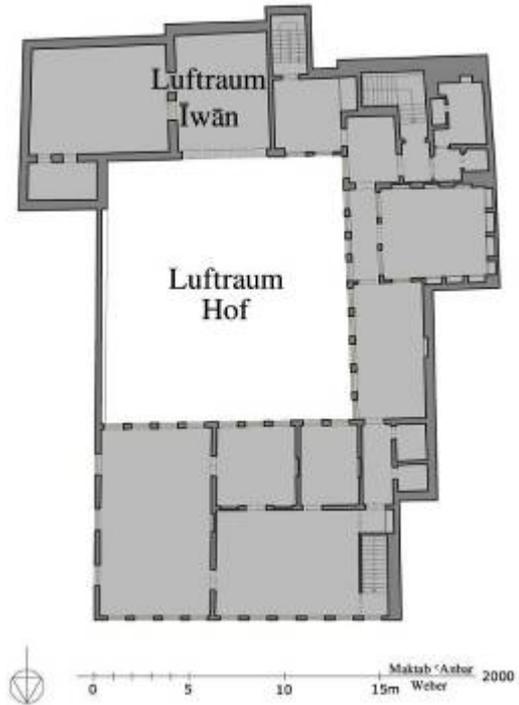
Bayt Mardam Bek, Grundriss OG
